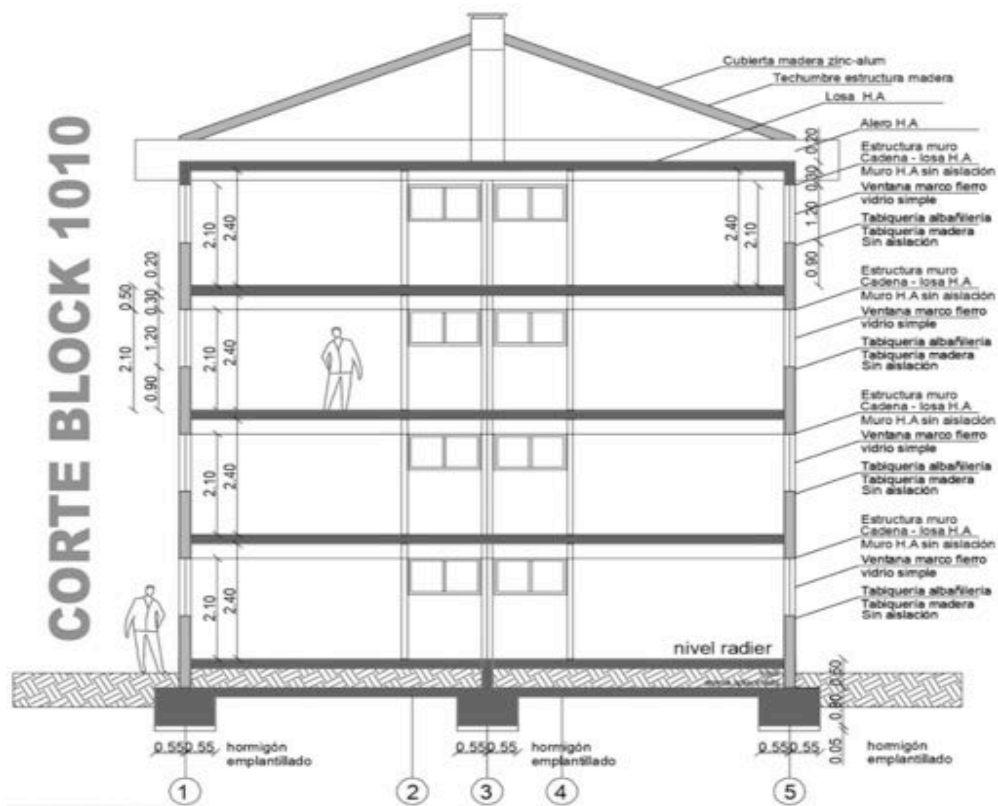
Corte elevación, Block 1010. Fuente: elaboración propia.
